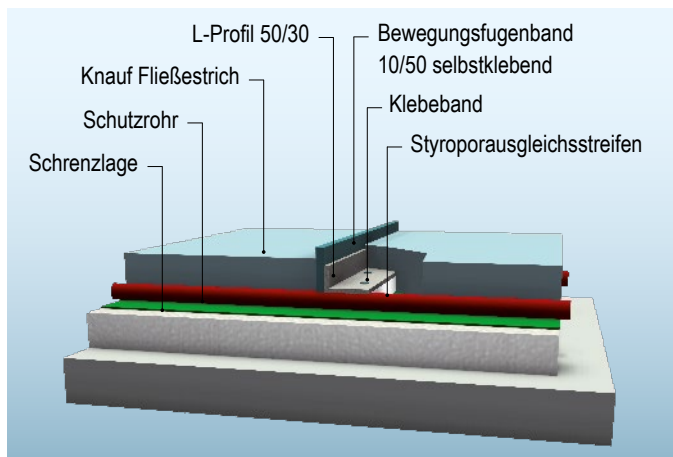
Ausführungsvariante 1: Fugen mit L-Profil
